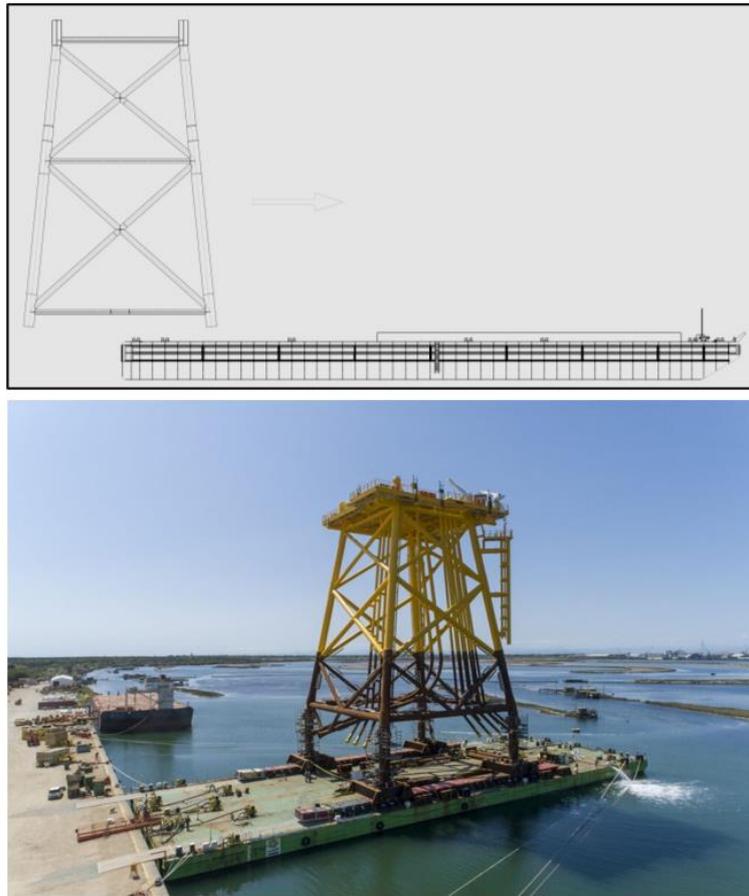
Load out della fondazione jacket sulla chiatte per il trasporto
